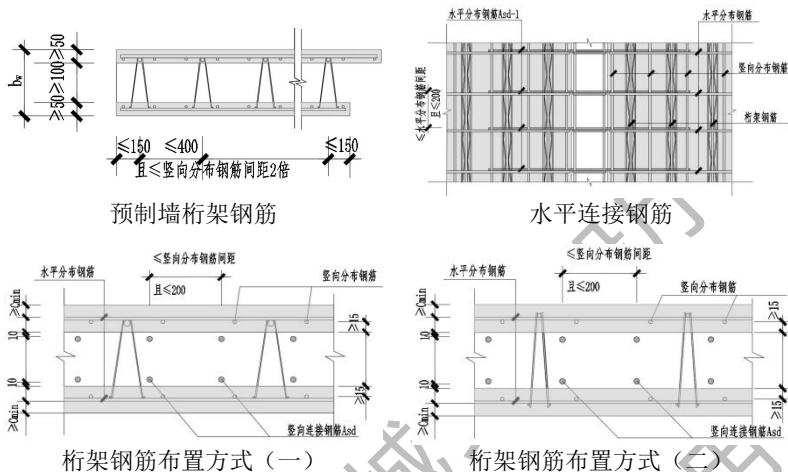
双面叠合剪力墙肢桁架钢筋和水平连接钢筋的构造要求
